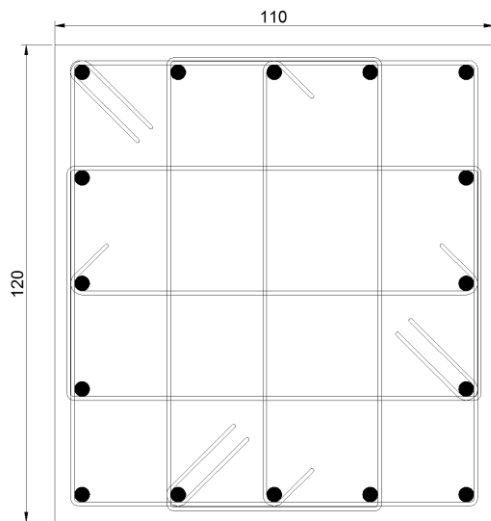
Detallado de acero longitudinal y estribos en columnas (continuación)
